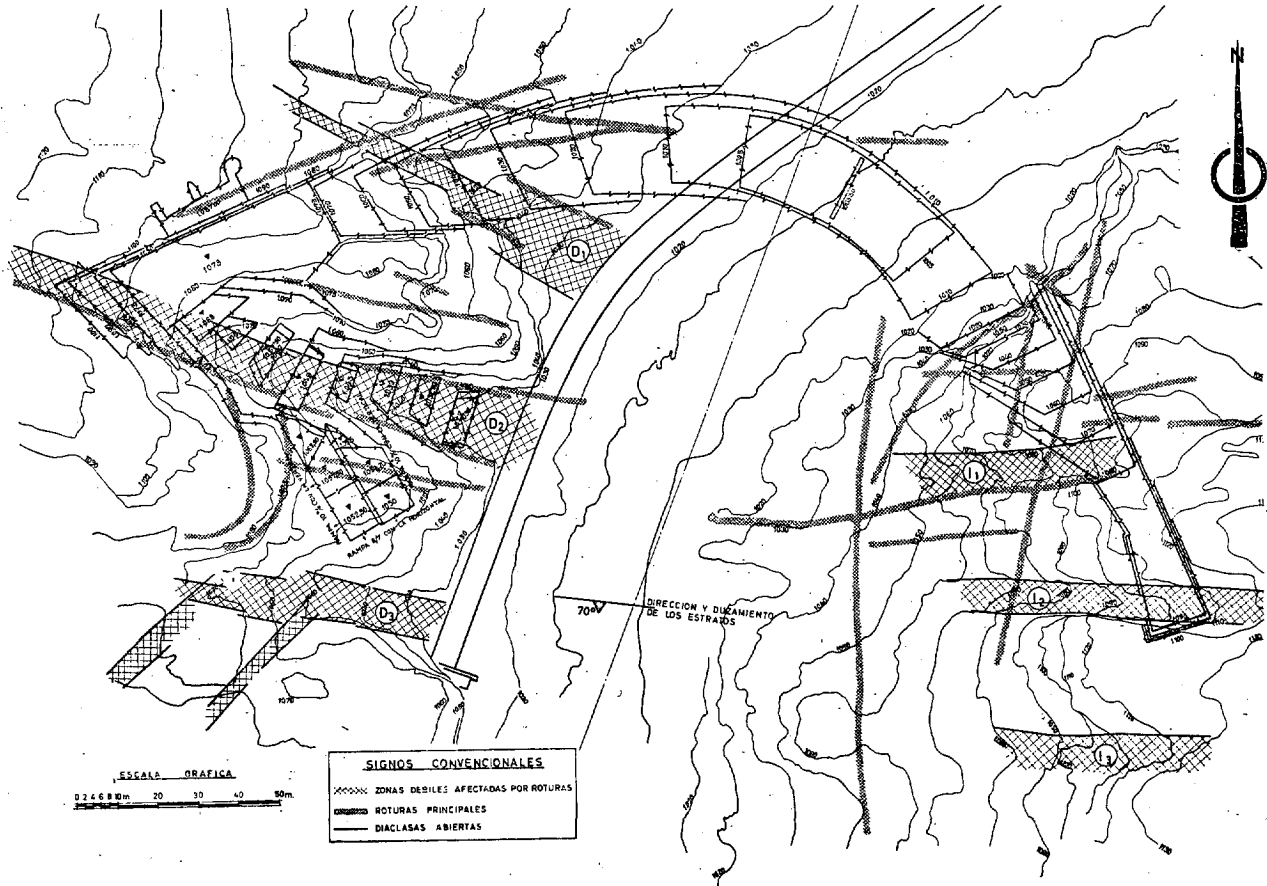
^a — Plano geotécnico y de excavaciones de la presa.
